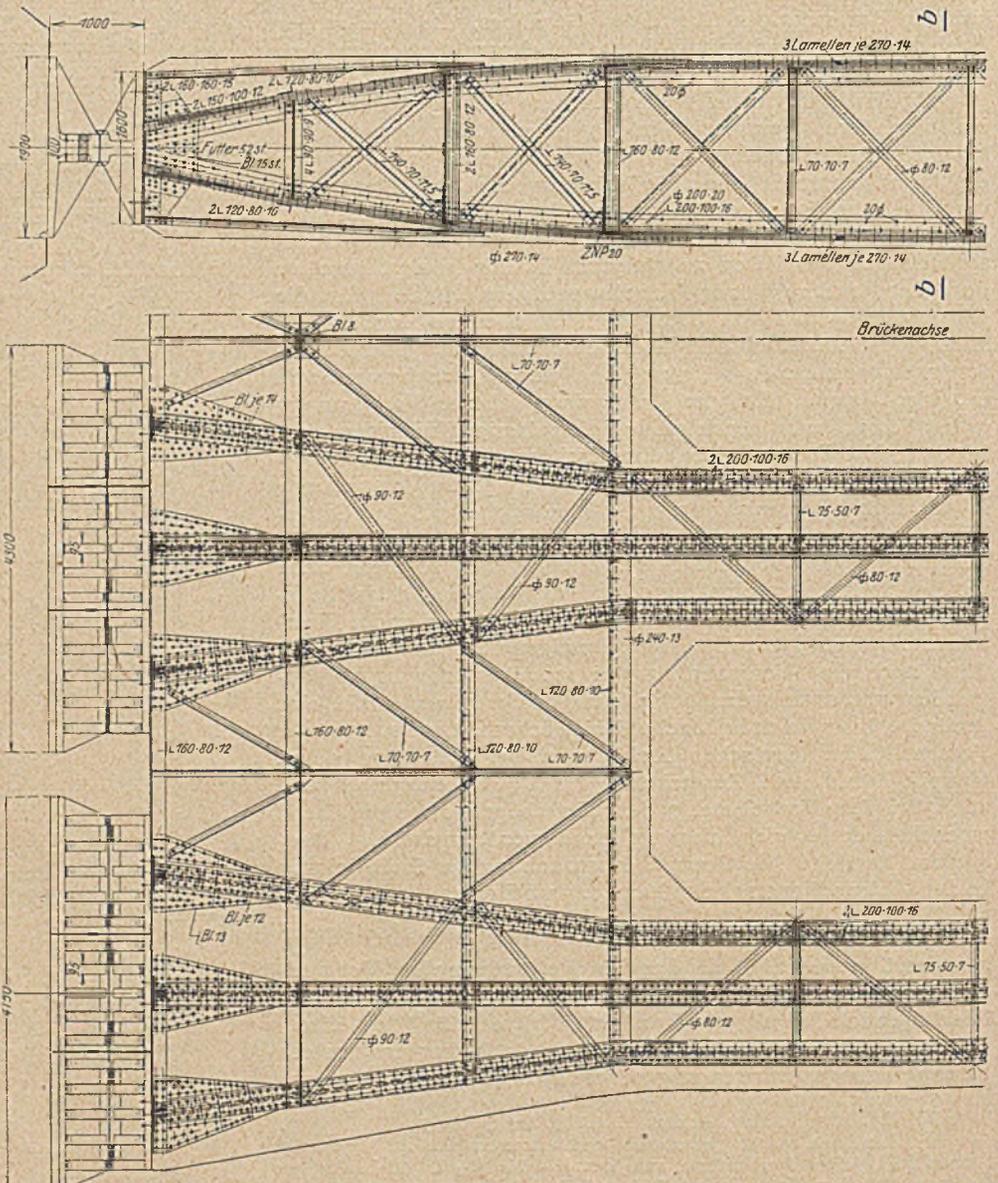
Entwurf Elbbrücke Dresden. Ausbildung der als Bewehrung der Hauptöffnung dienenden Gitterbögen an den Kämpfergelenken.
